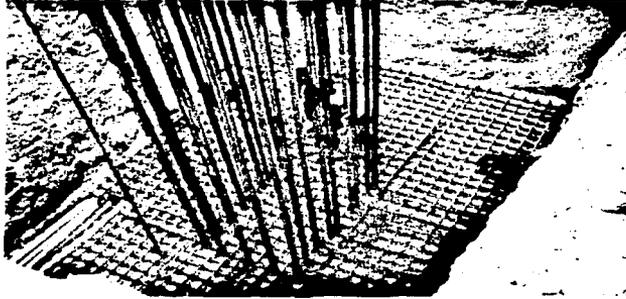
Colocación de acero de refuerzo (varillas) en zapatas y dados.
